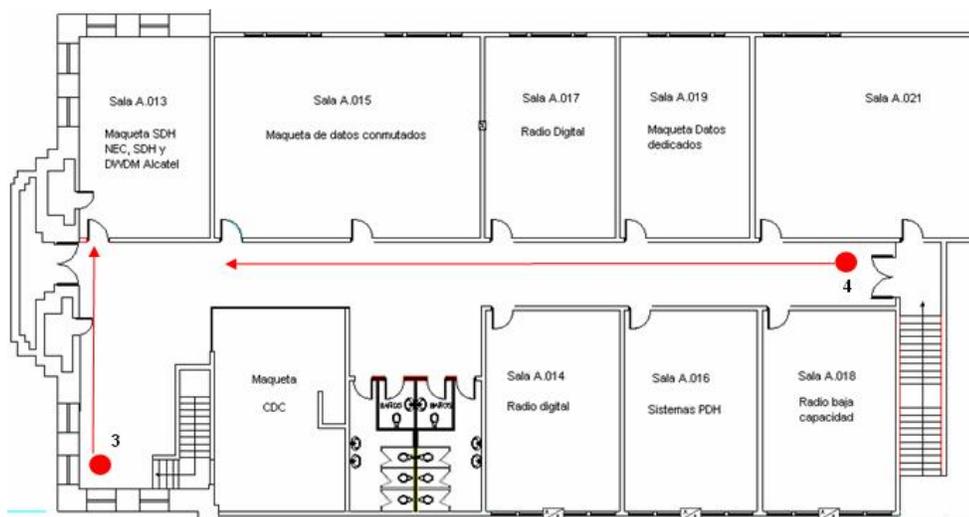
Ubicación de cámaras entrada edificio Arvelo planta alta
